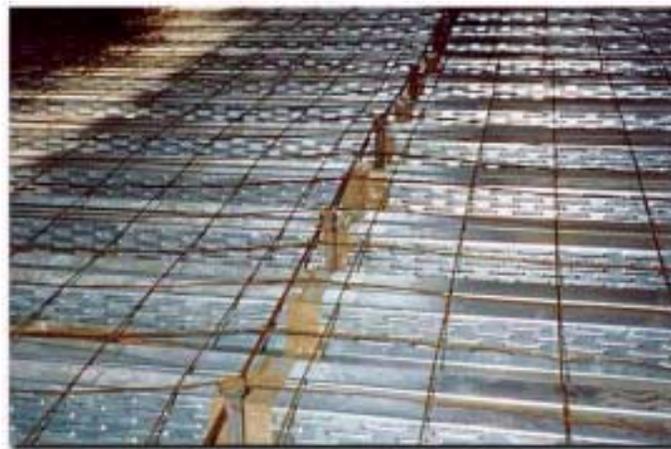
Laje mista + armadura de fissuração e negativa – CODEME¹⁸
